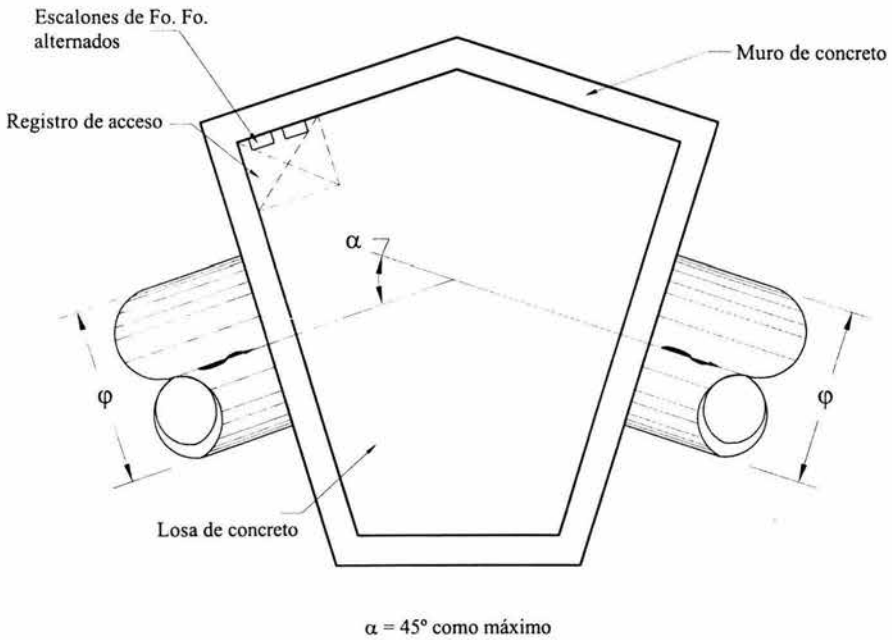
PLANTA POZO-CAJA DE DEFLEXIÓN
